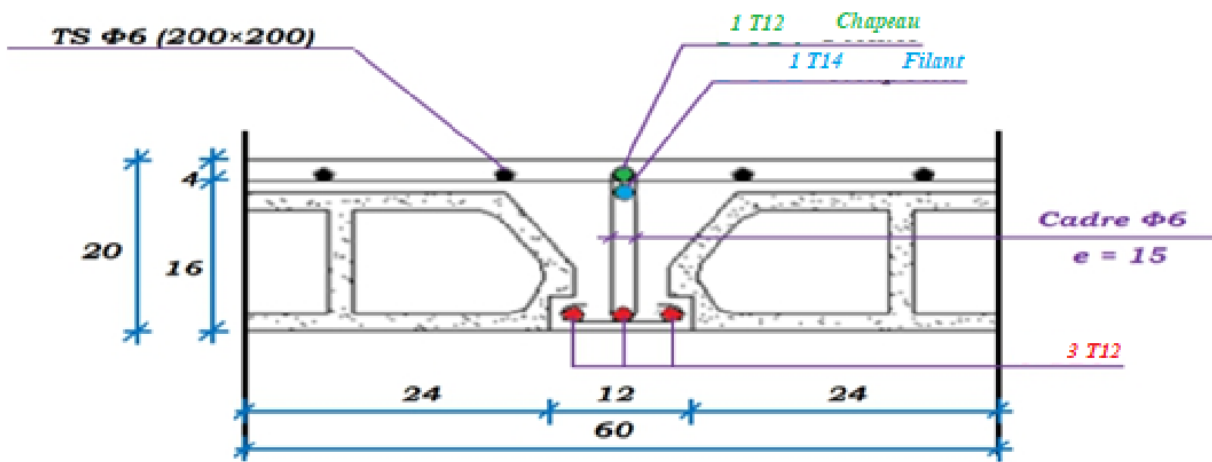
Schéma de ferrailage de la dalle de compression.
